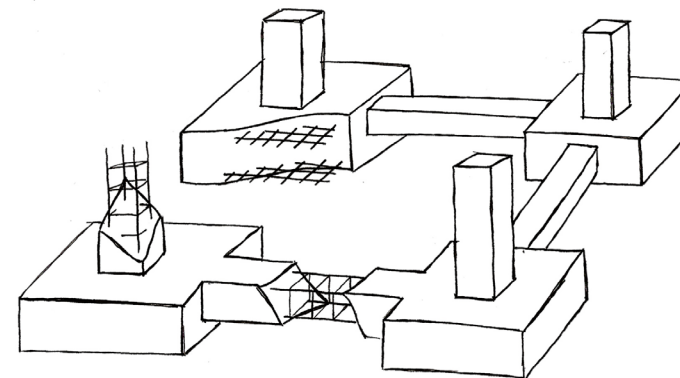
Boceto. Esquema tipo de cimentación por zapatas. Elaboración propia
